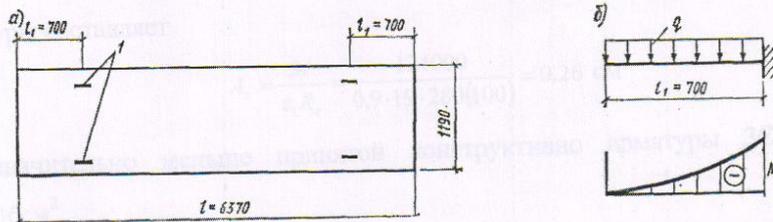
К расчету сборной панели перекрытия на монтажную нагрузку
